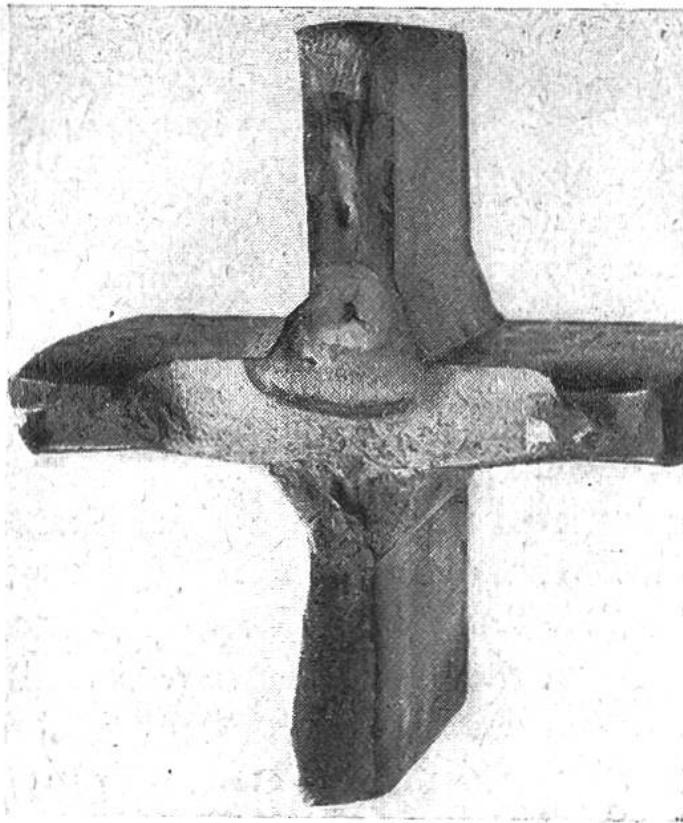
Ermüdungsbruch am geschweissten Kreuzungspunkt einer Fachwerkstrebe.
